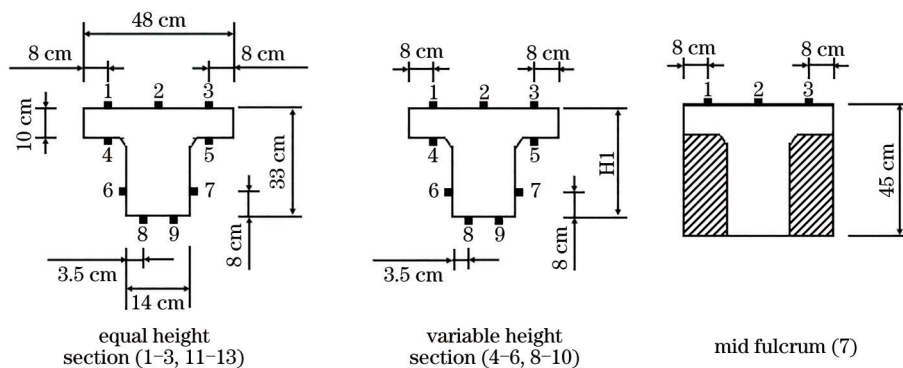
9.5 m 变截面连续 T 梁截面点位示意图
